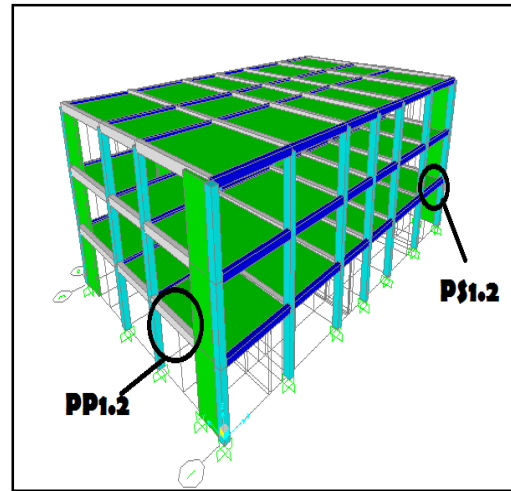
l'emplacement des poutres PP1.2 ; PS1.2
